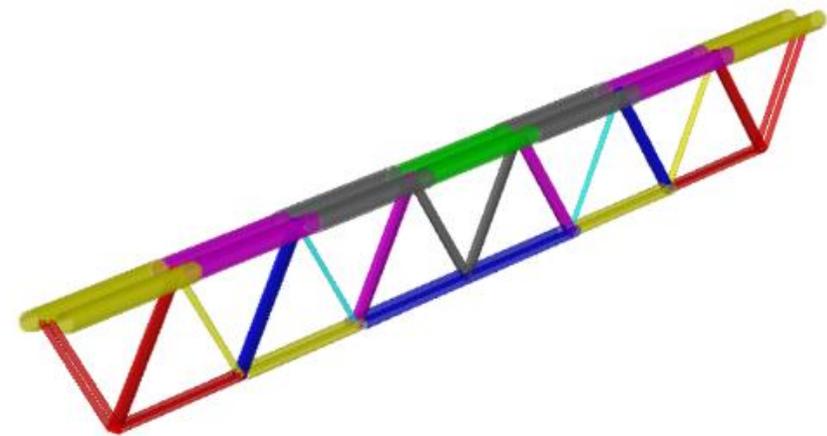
Axonometría del modelo de la viga Warren. Elaboración propia.
